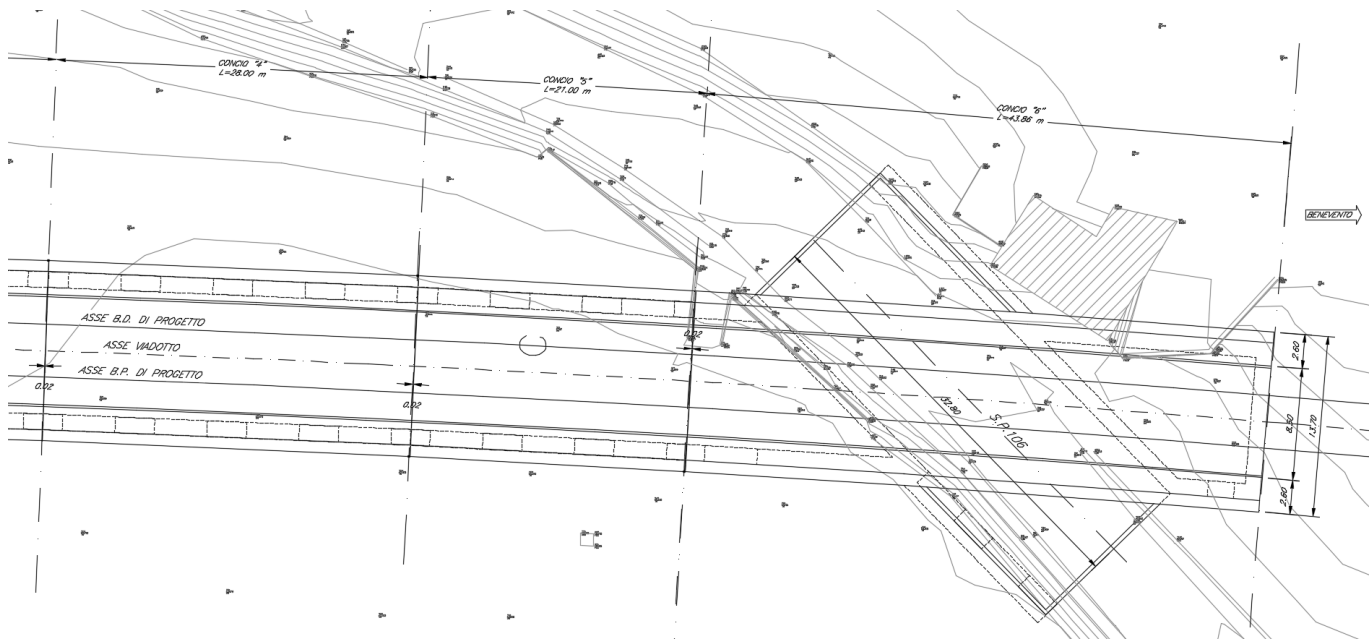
Stralcio planimetrico del VI14 – 2 di 2
